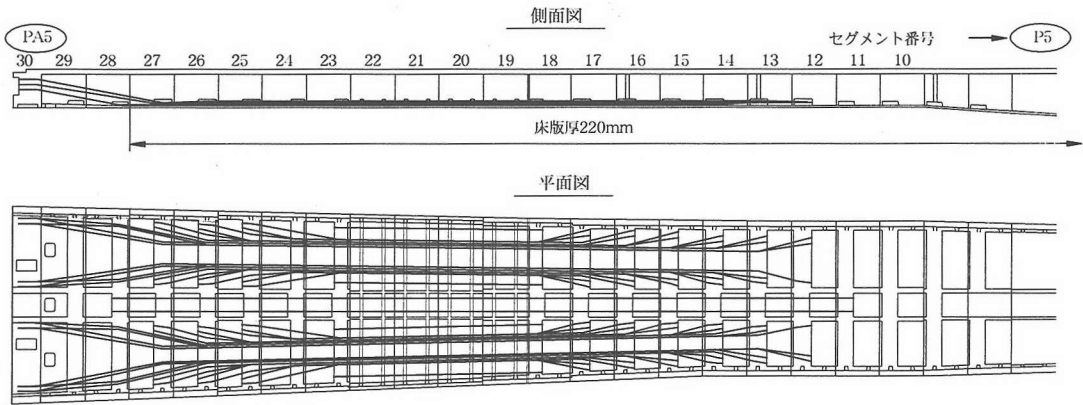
揖斐川橋西工区側径間の外ケーブル配置図
